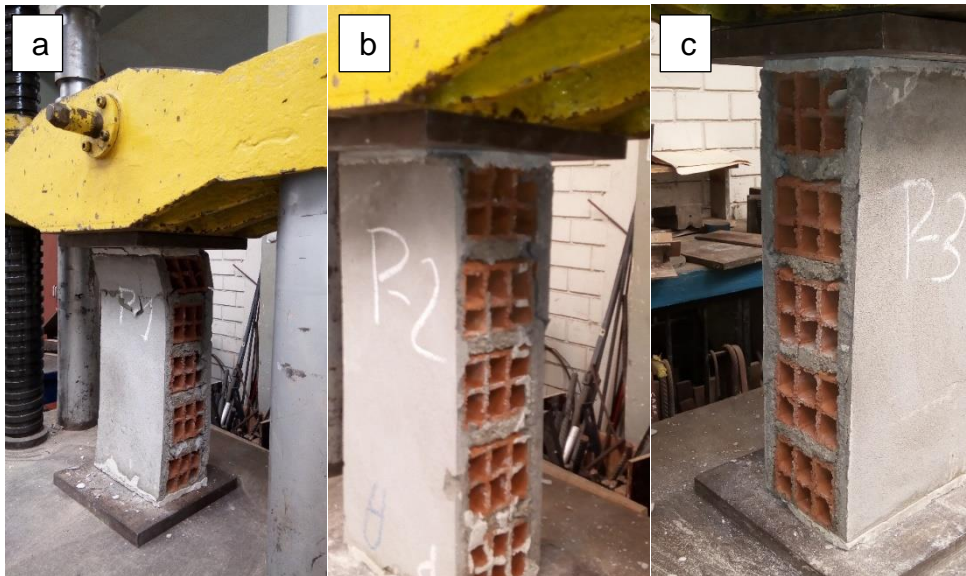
Proceso de ensayo pilas patrón P-1, P-2 y P-3 sin reforzamiento
